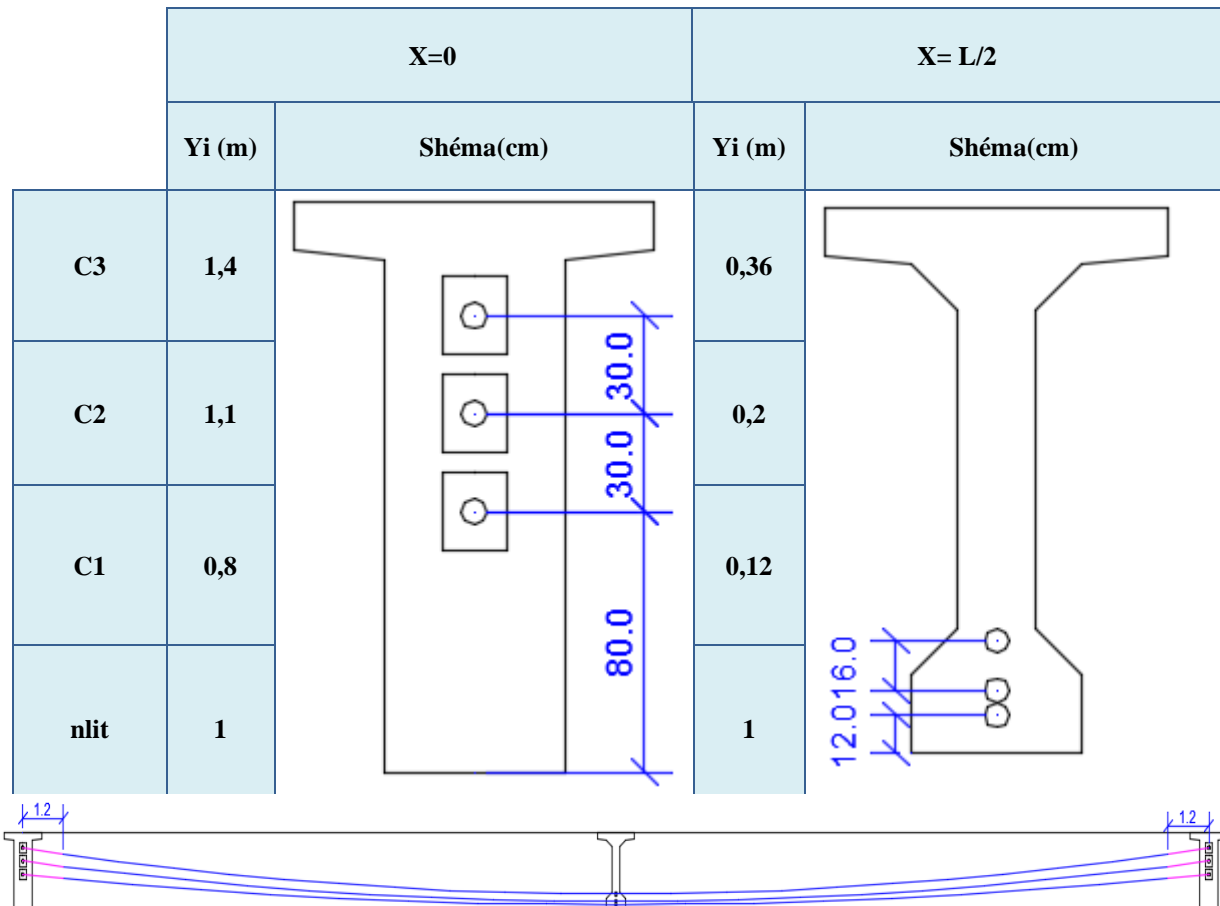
Tracé des câbles avec un alignement droit de 1,2 m à partir de l'encrage
